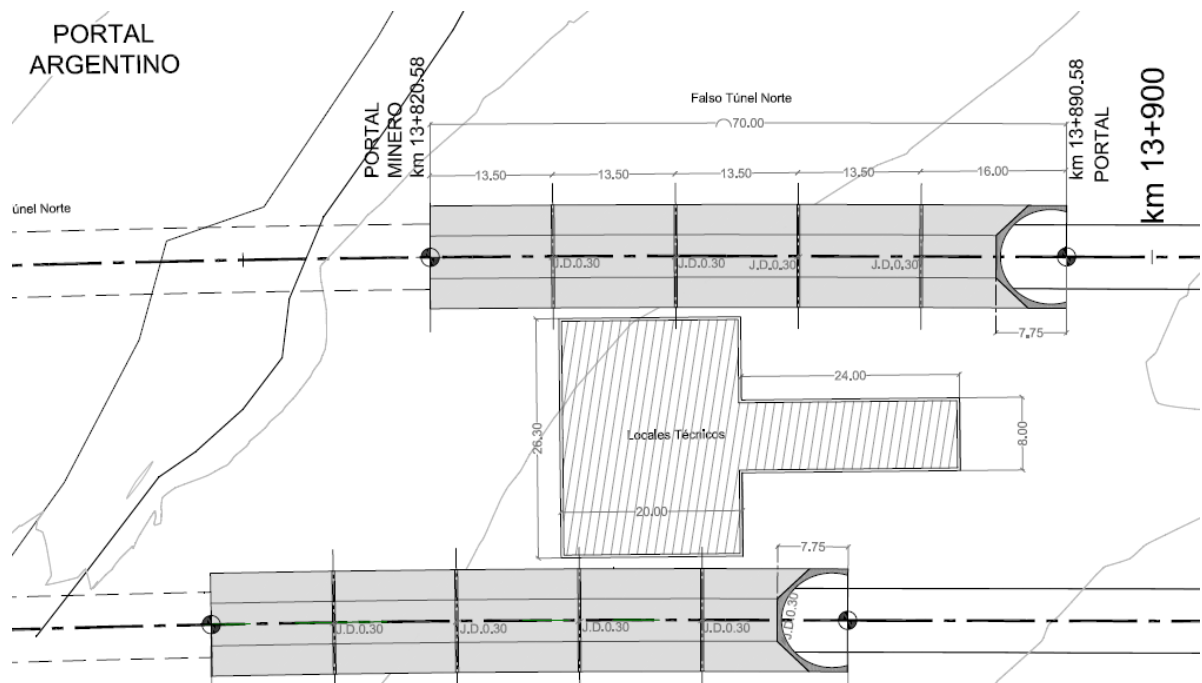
Túneles falsos y edificio técnico - Planta general
